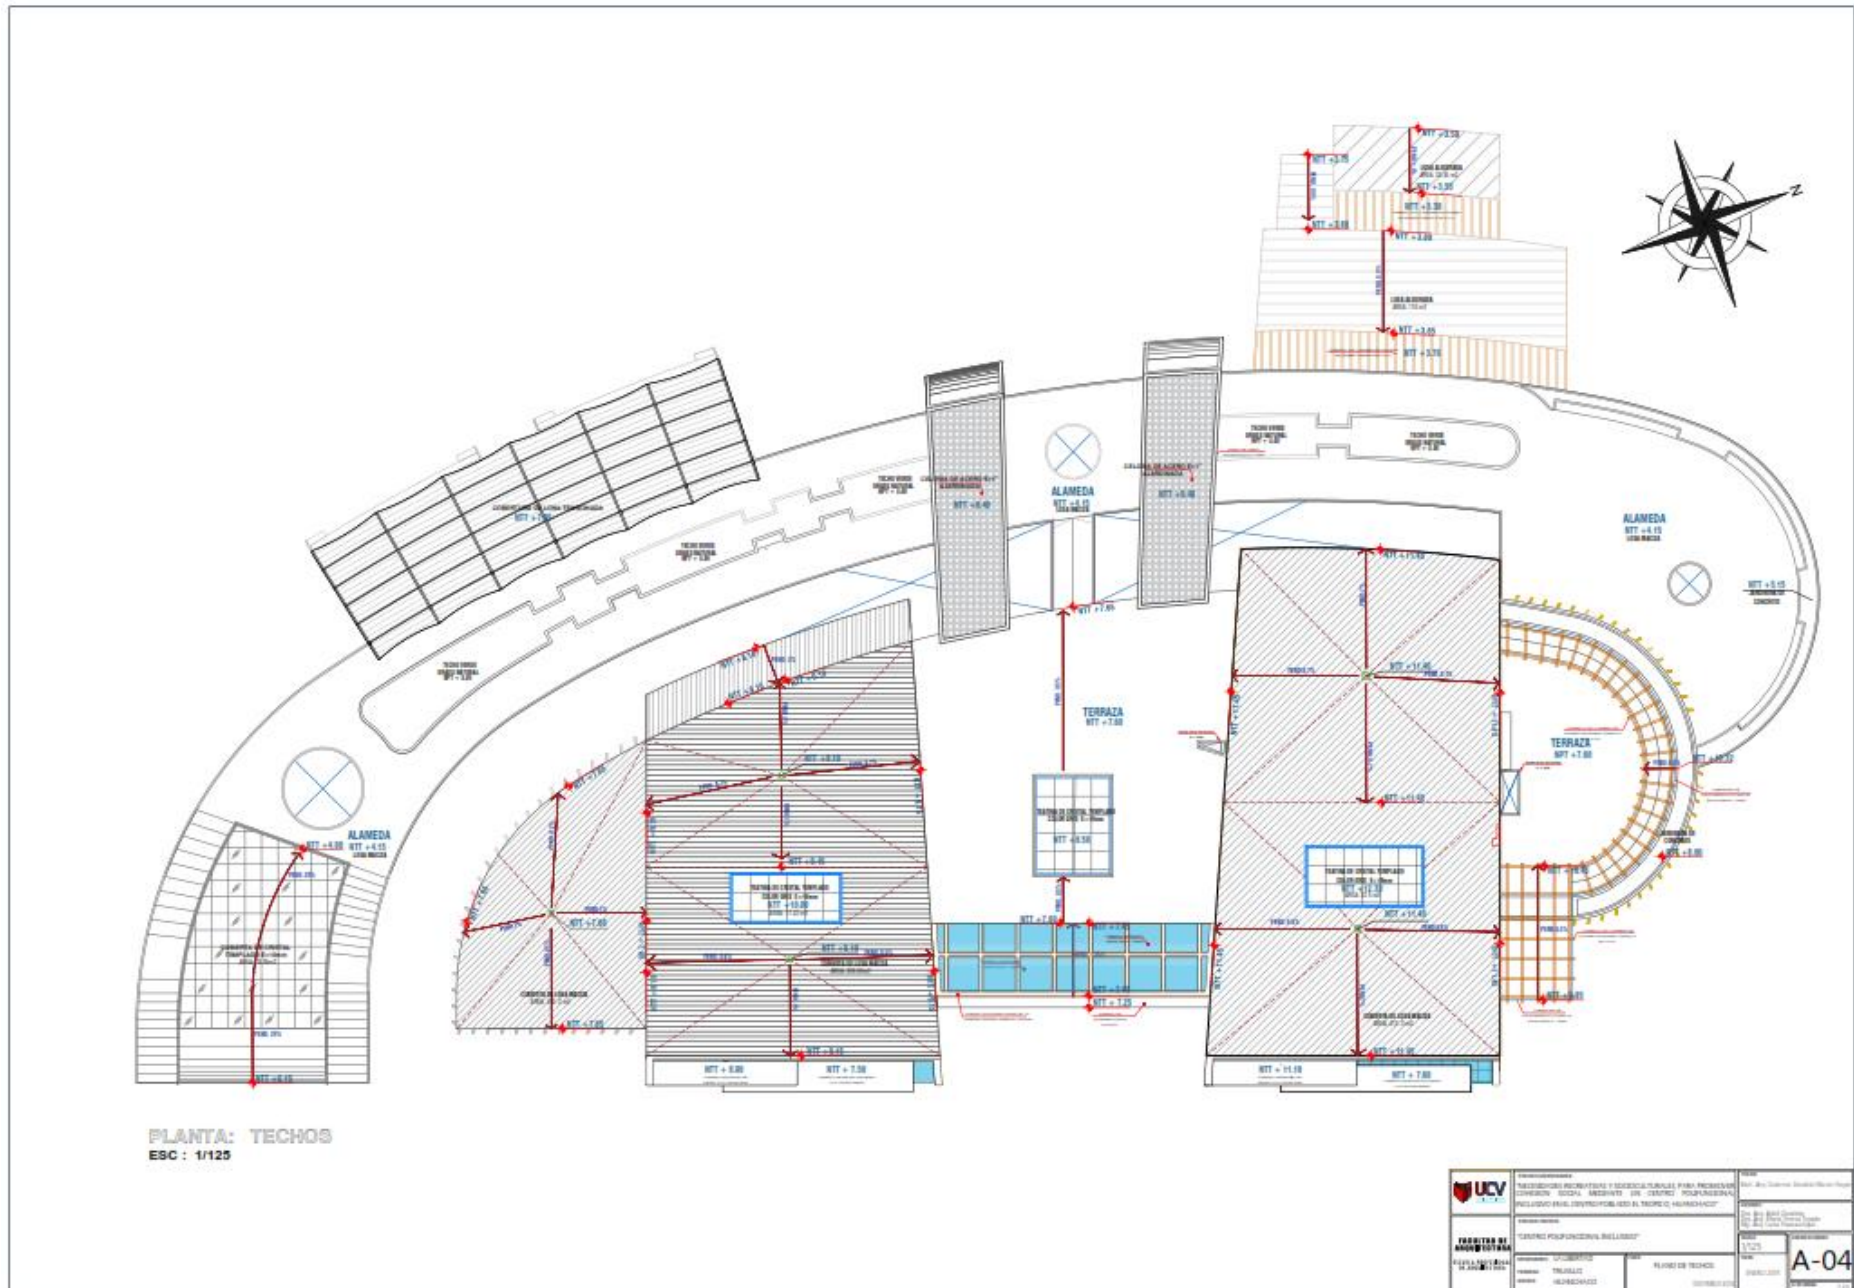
Plano de Techos: A-04. Fuente: Propia (2018)
